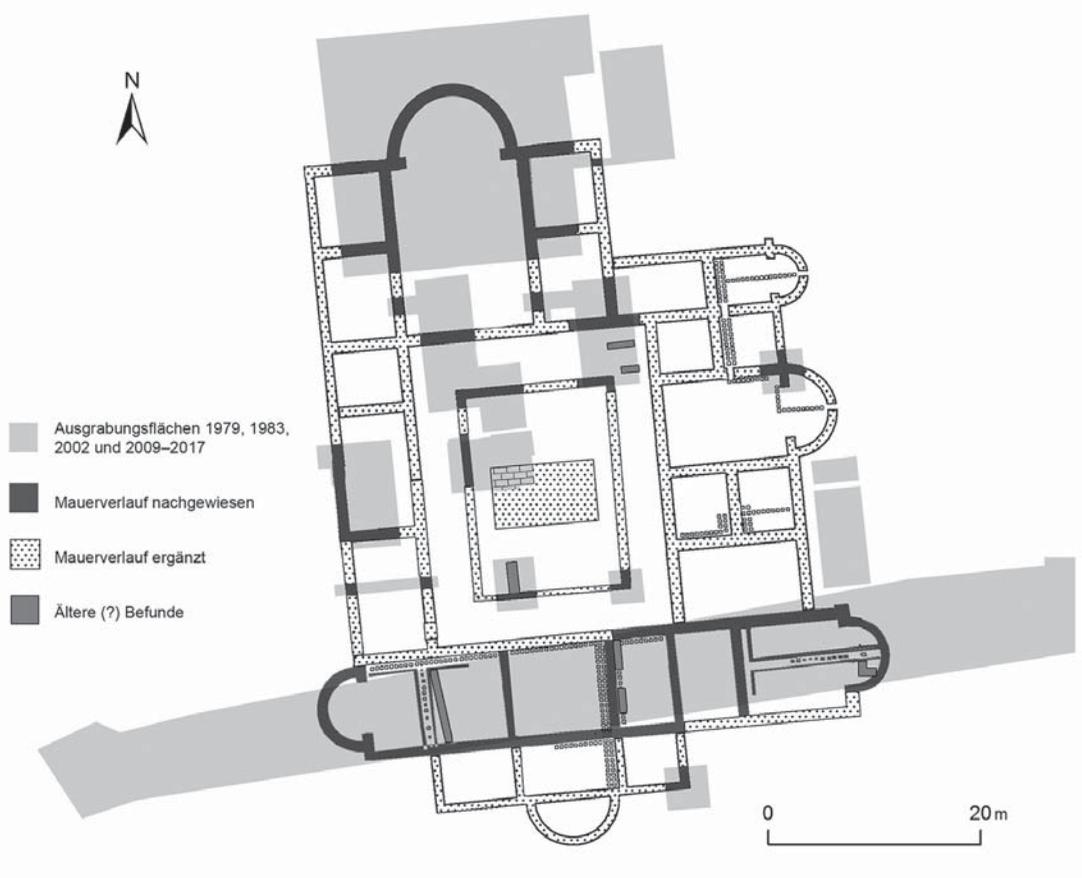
Rekonstruierter Grundriss der Bauphase A (Vorfestungsbauzeit) des Gebäudes 25 (Grafik: Autoren)
